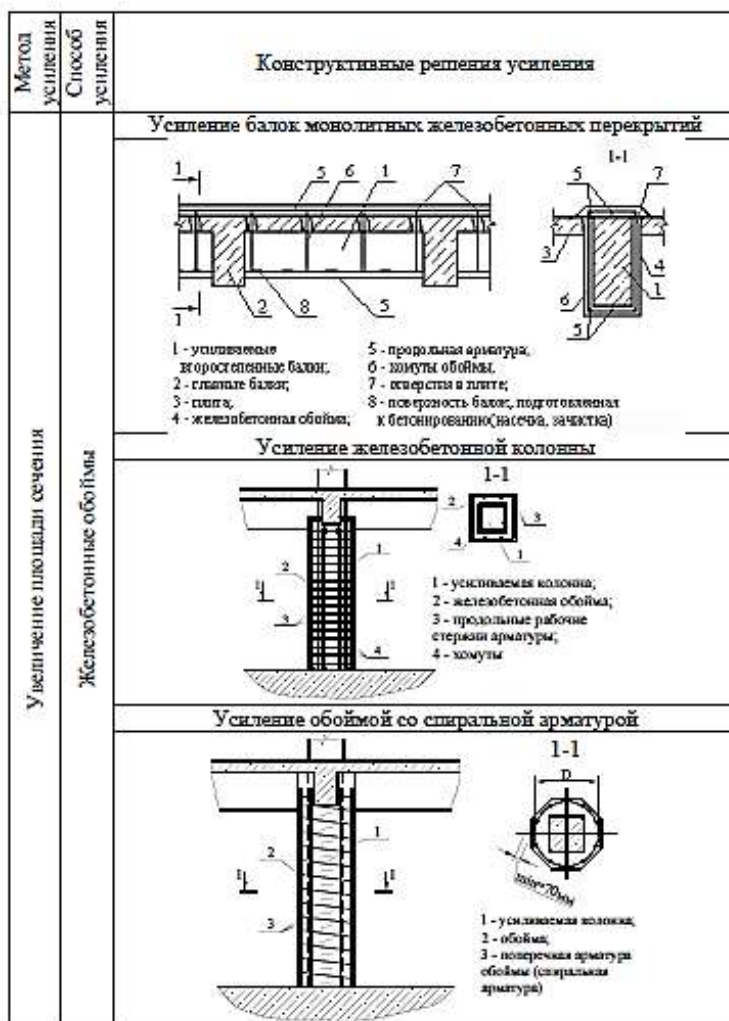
Варианты усиления железобетонных конструкций увеличением сечения различными способами обетонирования
